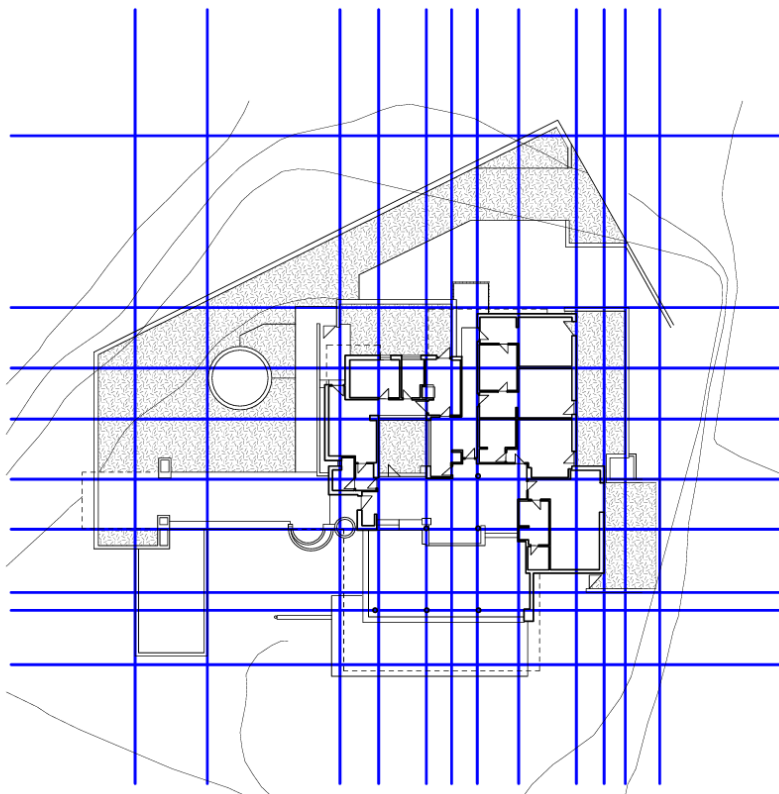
Planta de la Casa Baselga. Ejes. Elaboración propia.
